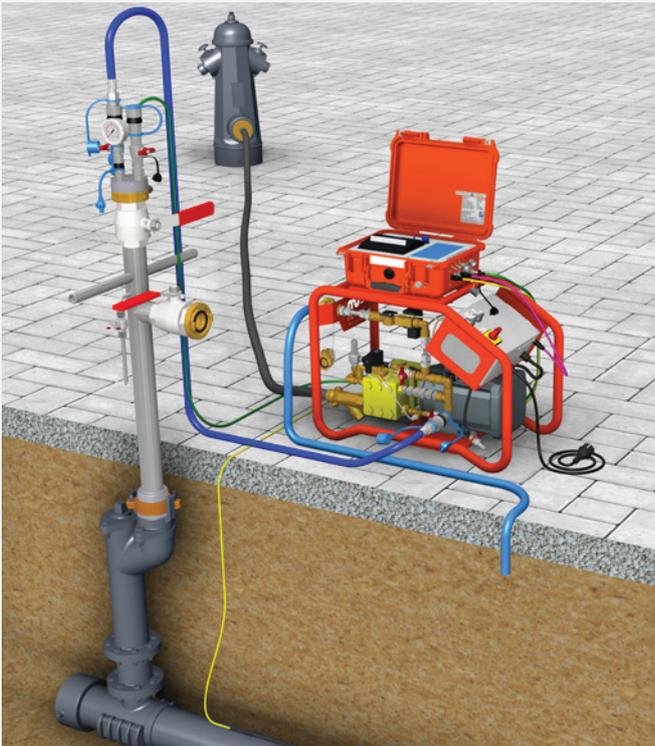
Prüfaufbau mit Pumpe EPP15-13-025-ADAMM
